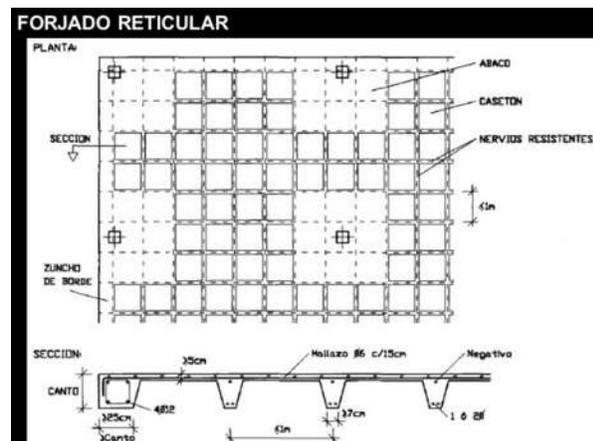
Armado de losa reticular. Fotografía tomada de la pág. <https://www.arqhys.com/articulos/losas-nervadas-reticulares>. Diciembre del 2017
